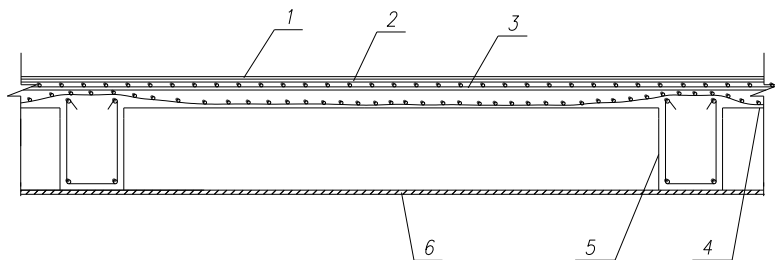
Схема усиления плиты монолитного ребристого перекрытия набетонкой сверху:
